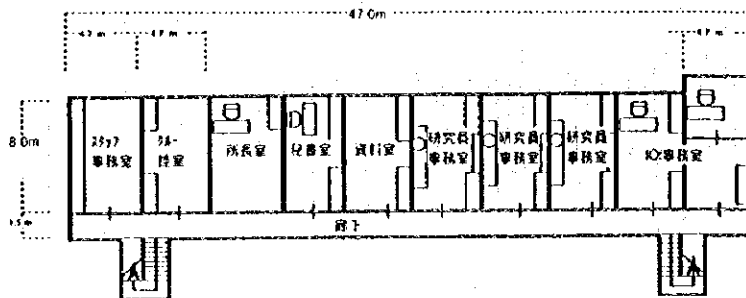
既存 MSP 管理研究棟 1 階平面図
